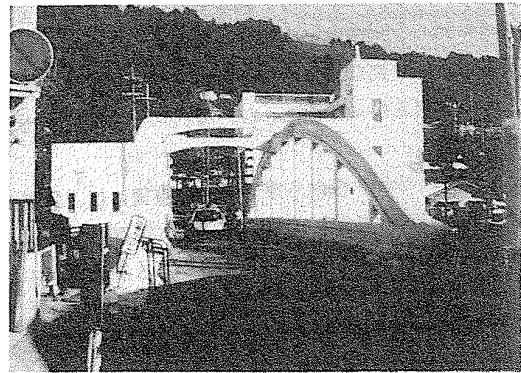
コンクリート・ローゼ大手橋 (木曽福島町)
